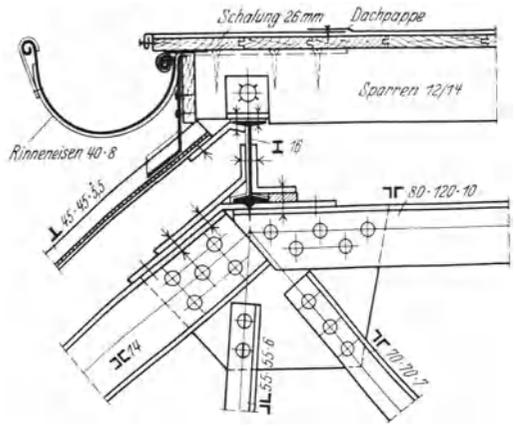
Eckknotenpunkt eines Mansardbinders.
